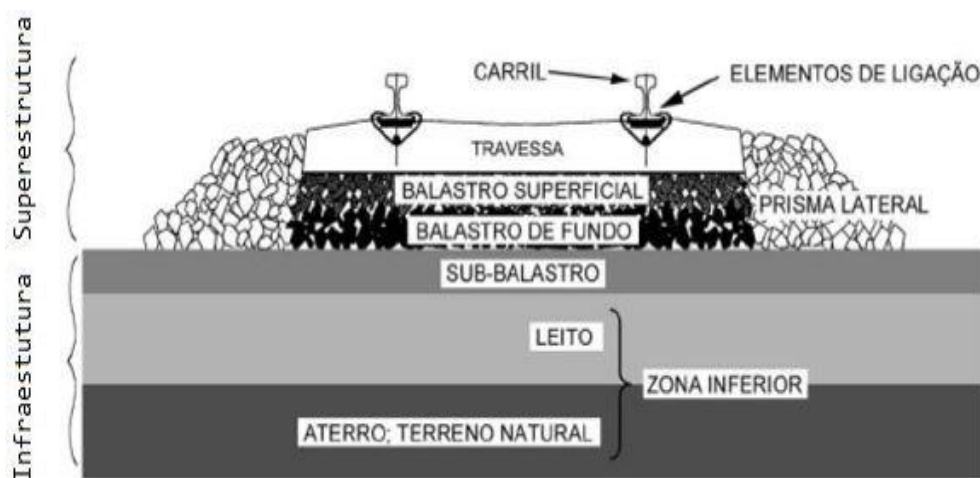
Perfil transversal de uma via balastrada "tipo" (Adaptado de: (9))
